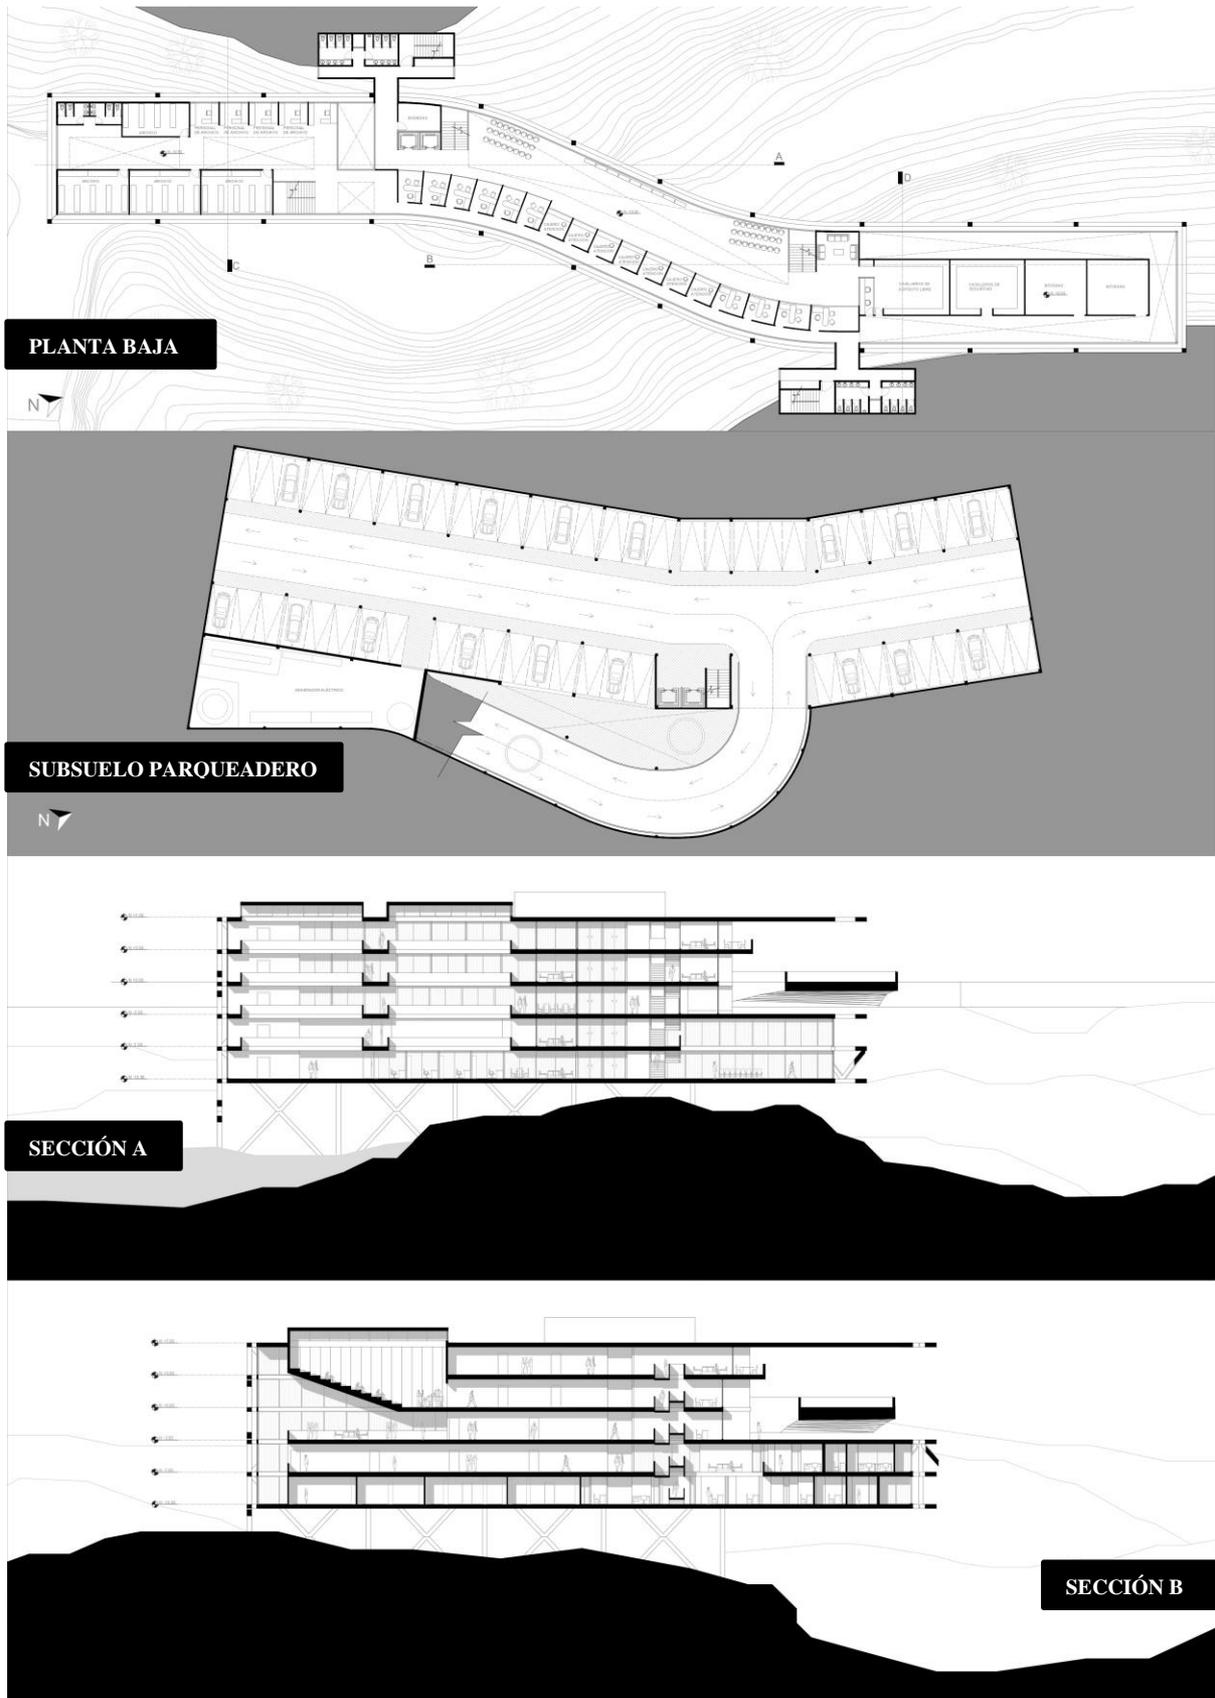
Planta baja, subsuelo de parqueadero y secciones A y B
